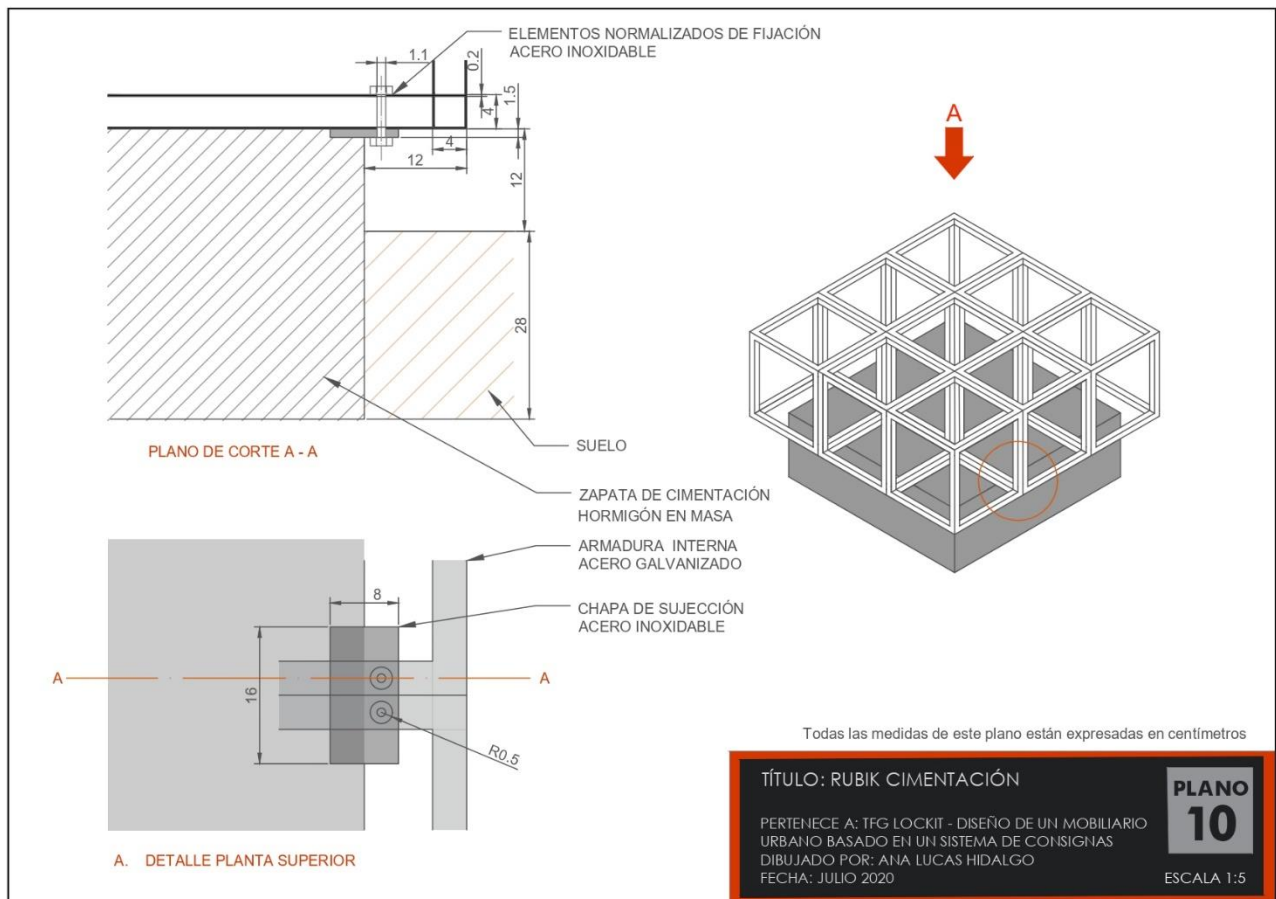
Plano del sistema de cimentación para LockIt Rubik&Go- Elaboración propia
